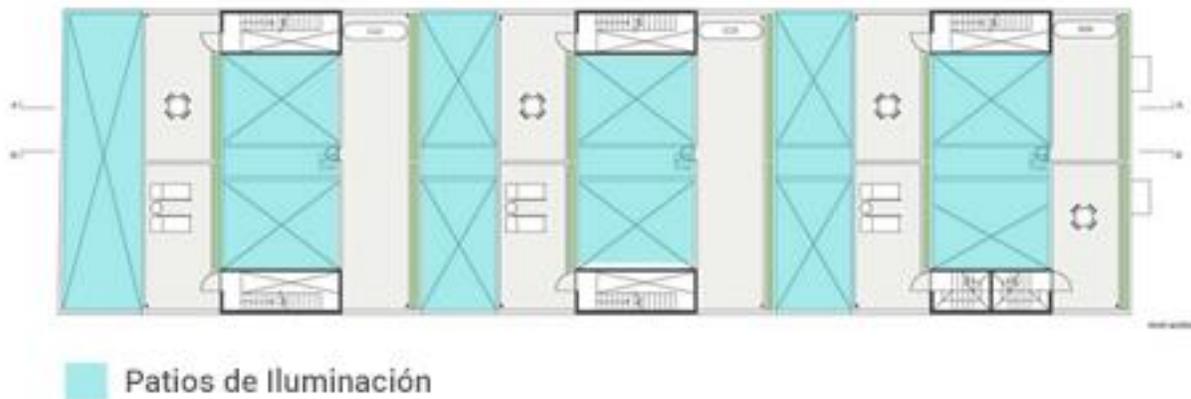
Patios de iluminación en planta. Extraído de ArchDaily.
